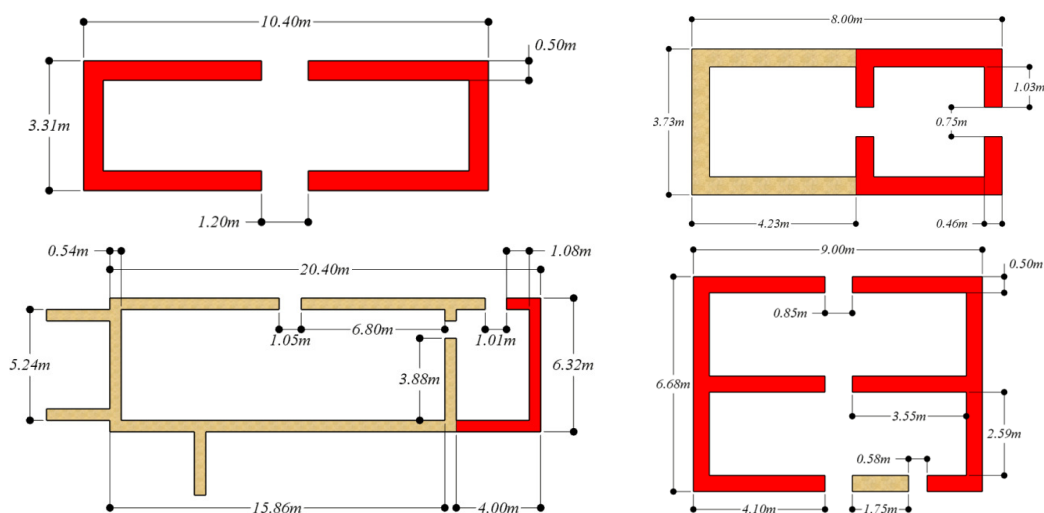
Exemplos de plantas estruturais representativas das construções de taipa levantadas [10].
